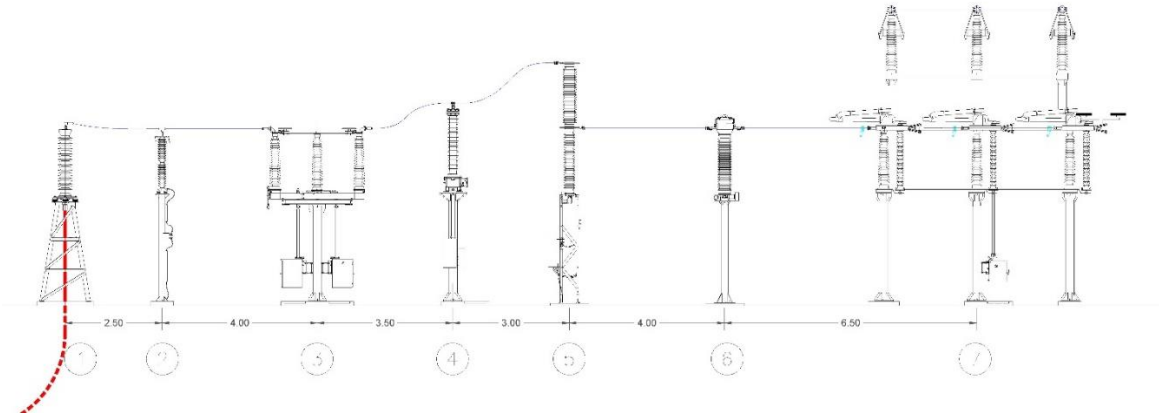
Sezione A-A' - Sistema di sbarre di raccolta AT
